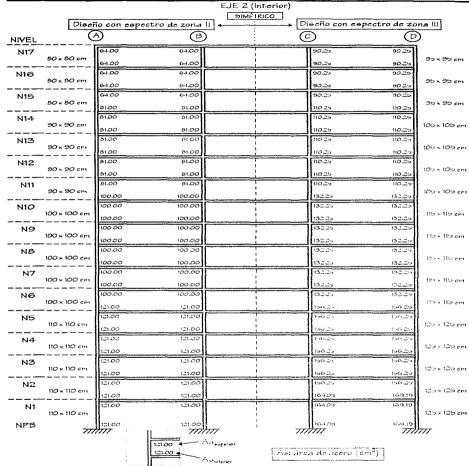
Comparación de cuantías de acero longitudinal de las columnas del marco del eje 2 de la estructura de 17 niveles discilada en las zonas II y III
